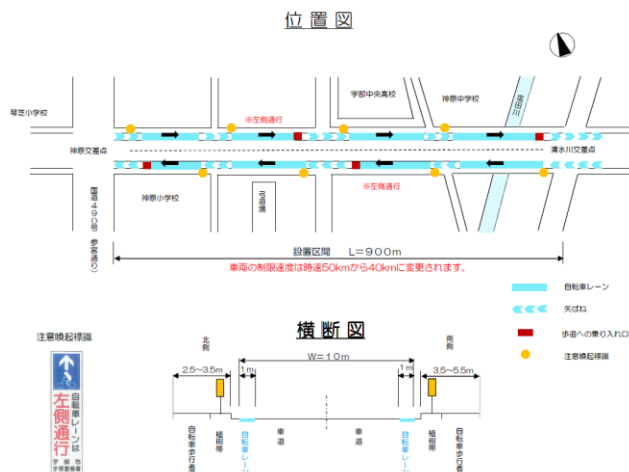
自転車レーン位置図（平面図・断面図）（出典：宇部市ホームページ）
